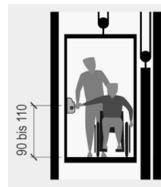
Aufzug Ansicht Abb. 18 - Aufzug Grundriss
